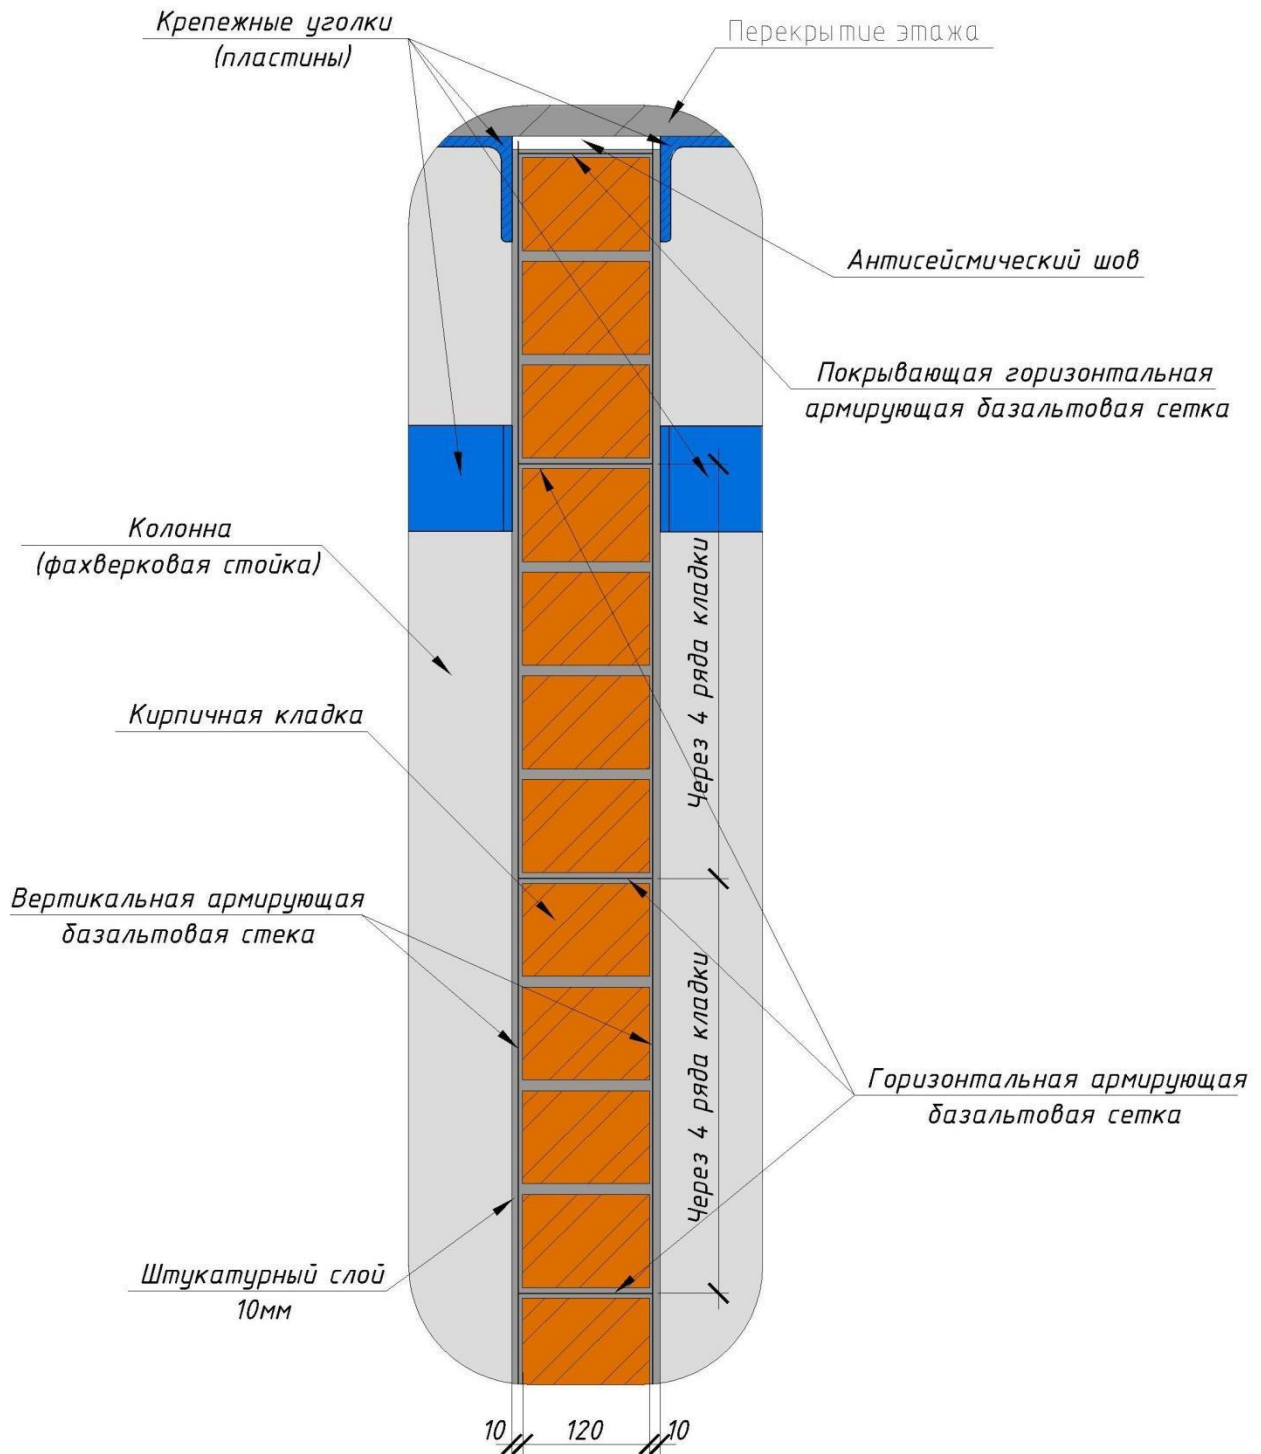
Схема крепления кирпичной перегородки, усиленной базальтовой сеткой, к каркасу здания. Горизонтальное сечение (при толщине перегородки 25см)
